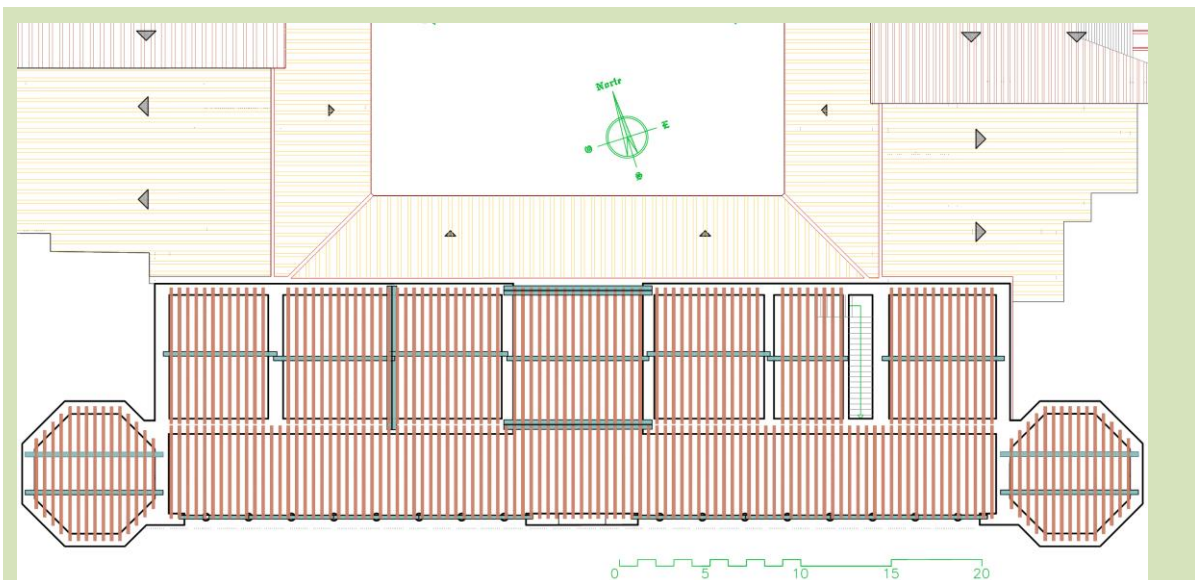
Reconstrucción ideal del forjado de la primera planta del ala sur. CGS.
